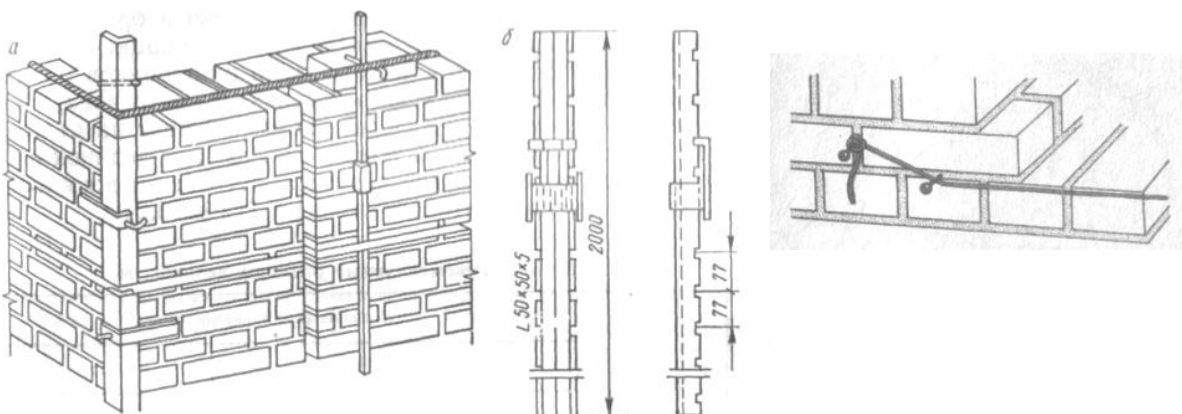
Інвентарна металева порядовка: а – загальний вигляд установки на стіні; б – рейка порядовка; в - причалка з цвяхом
